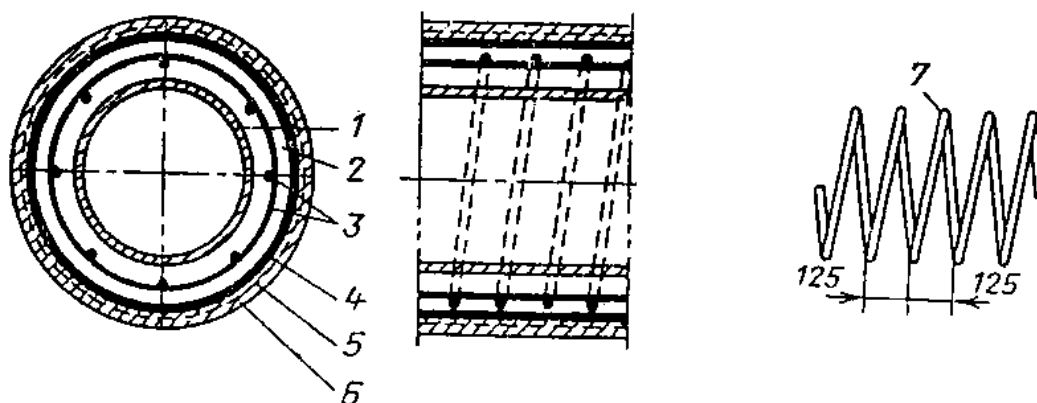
Монолитная армопенобетонная изоляционная оболочка
